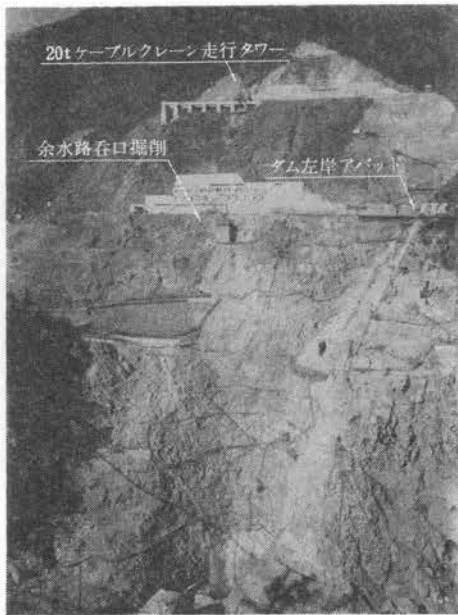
奈川渡ダムサイト左岸施工状況 (41年10月末)
